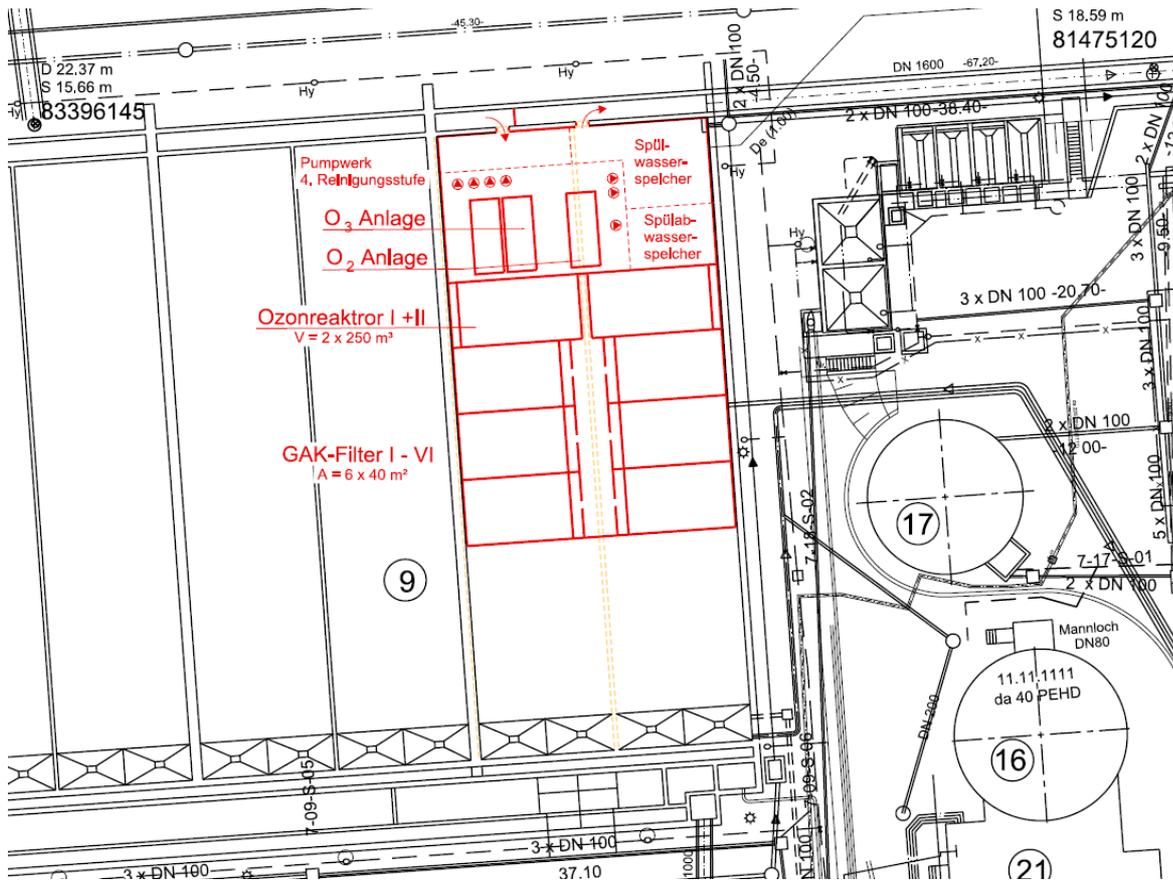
Lageplanausschnitt Variante 4: Ozonung mit nachgeschaltetem BAK-Filter
